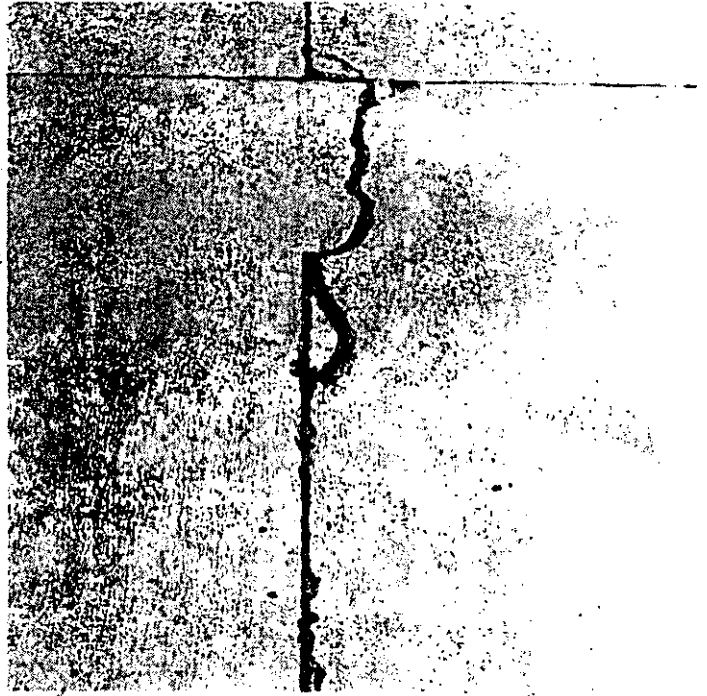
Grieta cercana a la junta debida probablemente al aserrado extemporáneo de la junta, durante la construcción
